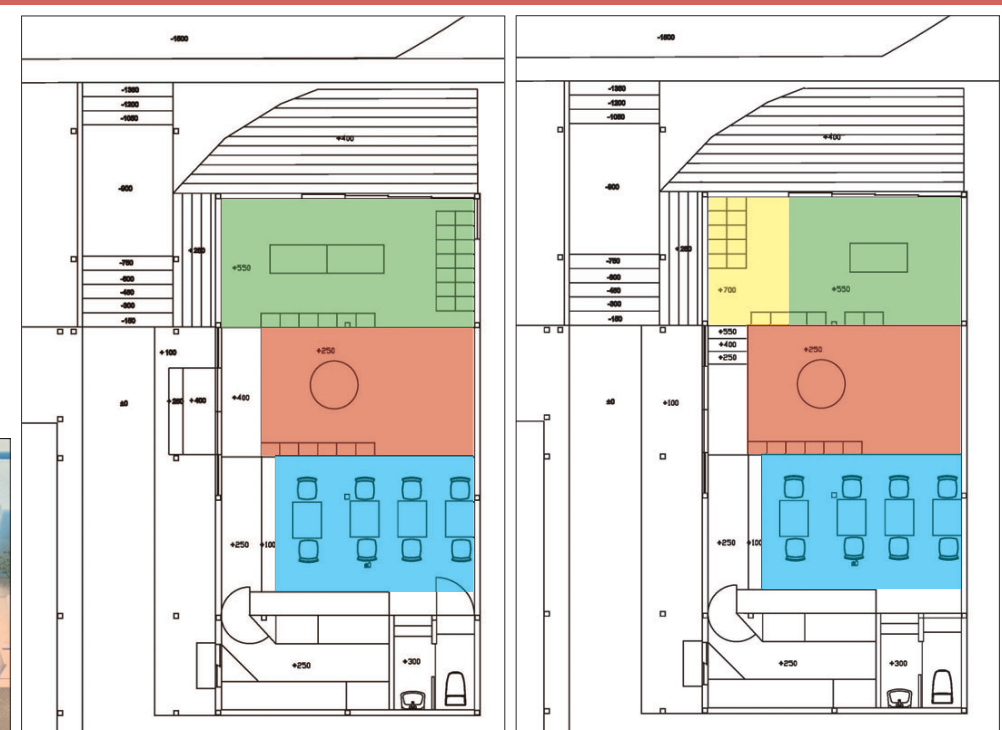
第3回目ワークショップ パターン① 3段構成平面図 1/80
